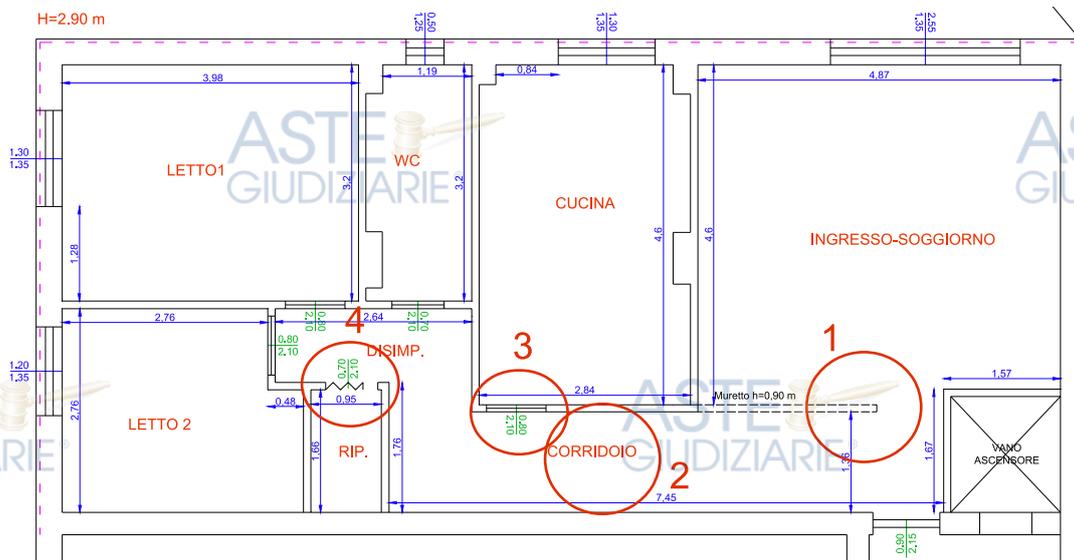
Raffronto planimetria stato di fatto e planimetria catastale - BENE A - foglio 101, particella 163 subalterno 3
